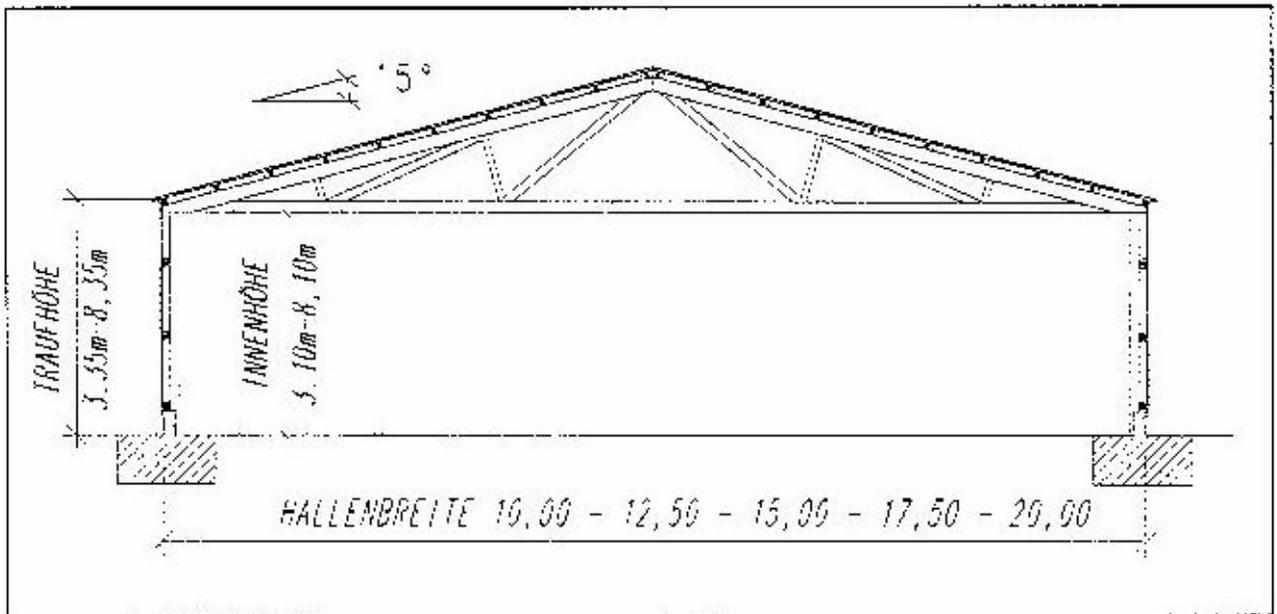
Lager- und Maschinenhalle (Werkbild A. Conrads Holzbaubetrieb)
